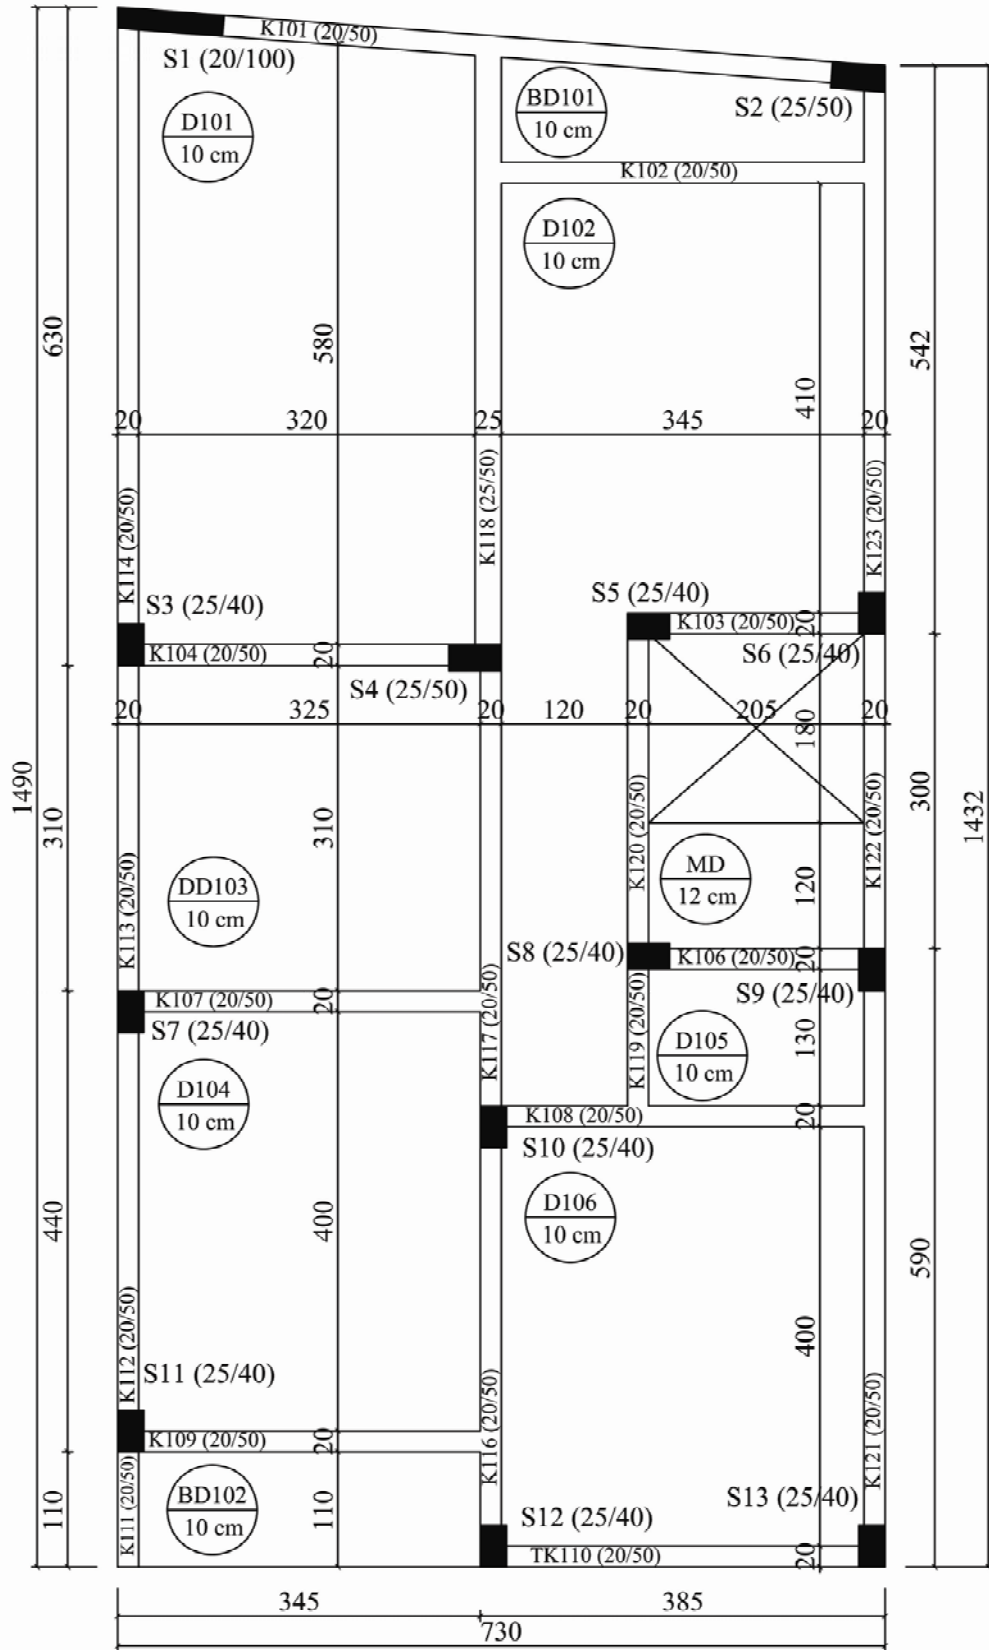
B3\_1'in 2. ve 3. kat kalıp planı
